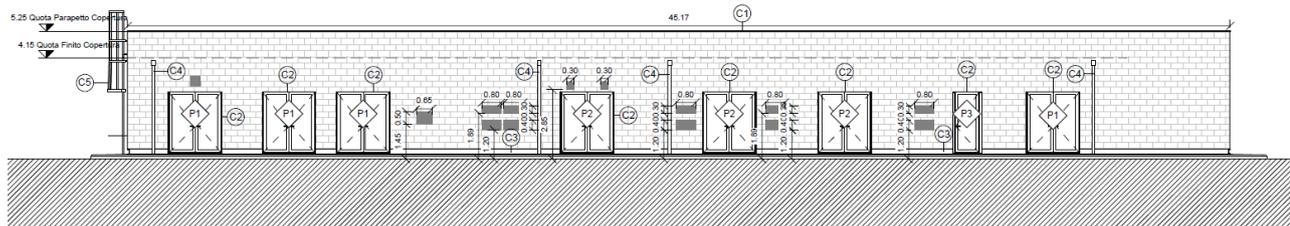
FA08. Prospetto Fabbricato PPM Stazione Pontecagnano Aeroporto
